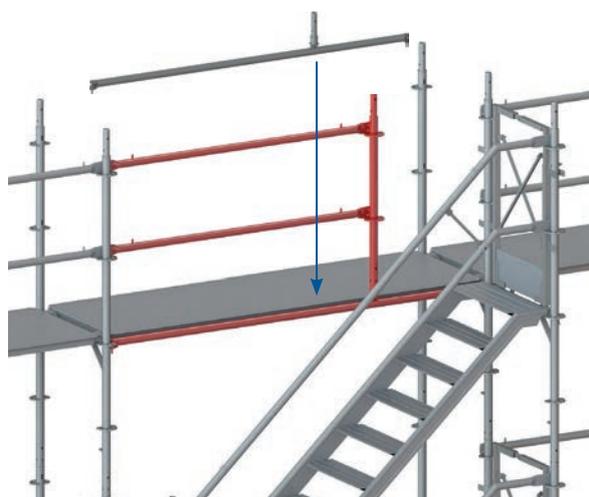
Montage de la barre de verrouillage d'escalier, du poteau de garde-corps et des entretoises de garde-corps
